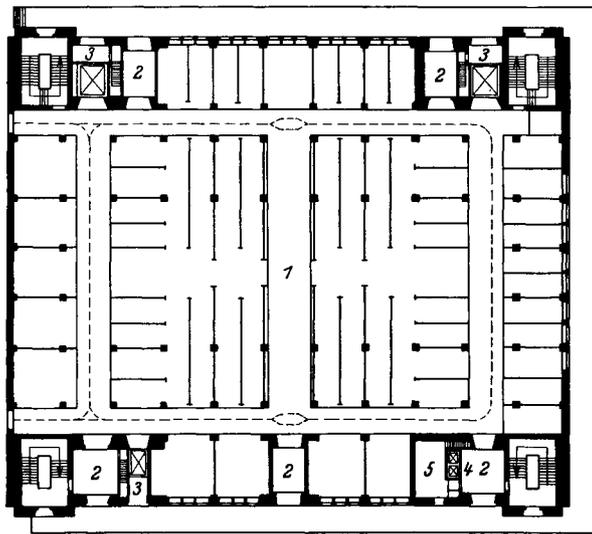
Fleischgroßmarkthalle (Chemnitz). Grundriß des Erdgeschosses.
